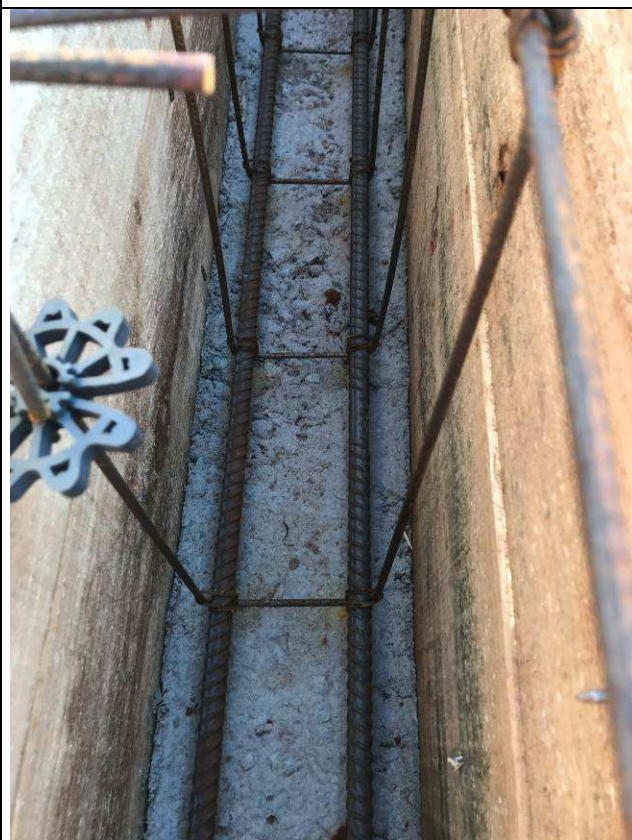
C: Lastro de concreto no fundo das vigas baldrames do prédio do arquivo.
